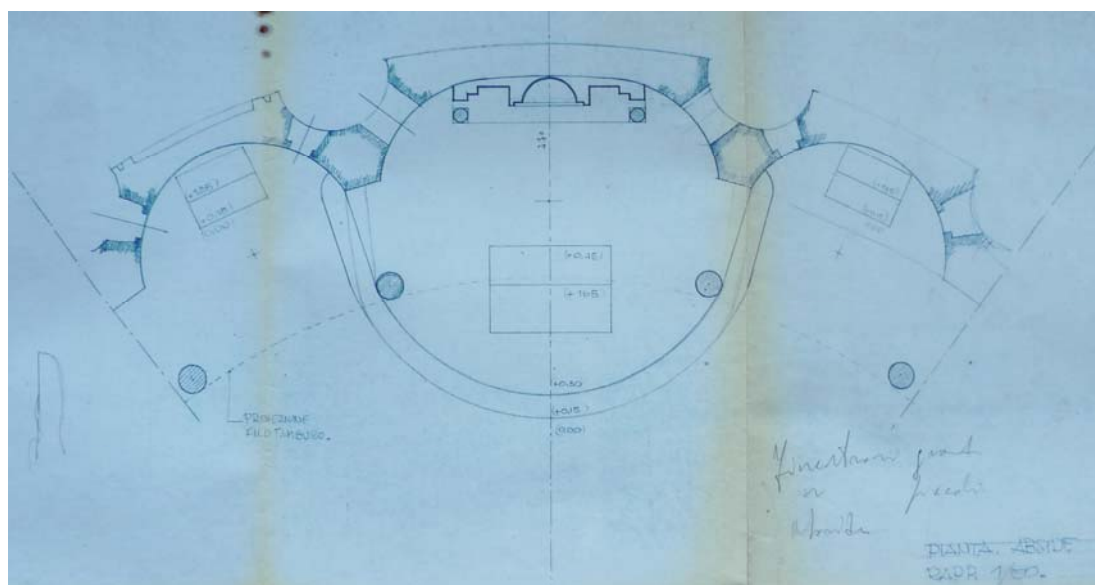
M. Canino, pianta del presbiterio di San Pietro in Cattedra (Archivio Parrocchia San Pietro in Cattedra).
